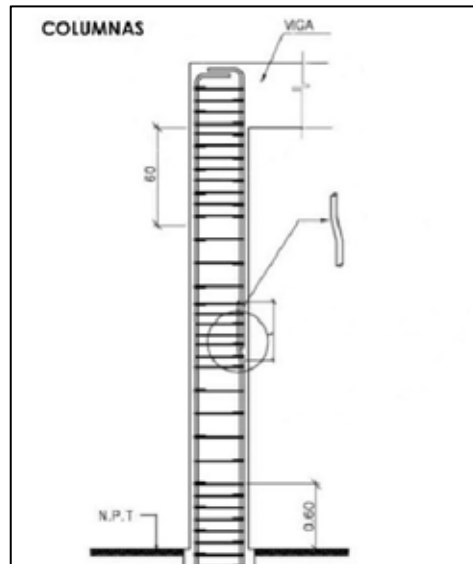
Columnas de Concreto. Fuente: <http://columnasdeconcreto.blogspot.com> (2012).
